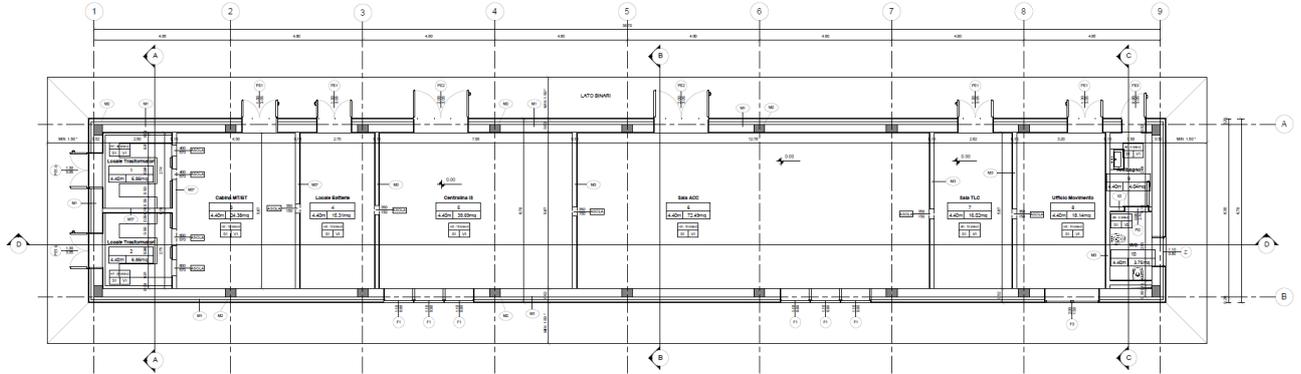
PM Turago – Pianta Architettonica Piano terra
